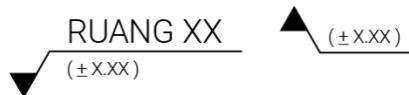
Penempatan Simbol Nama Ruang pada Gambar Denah
